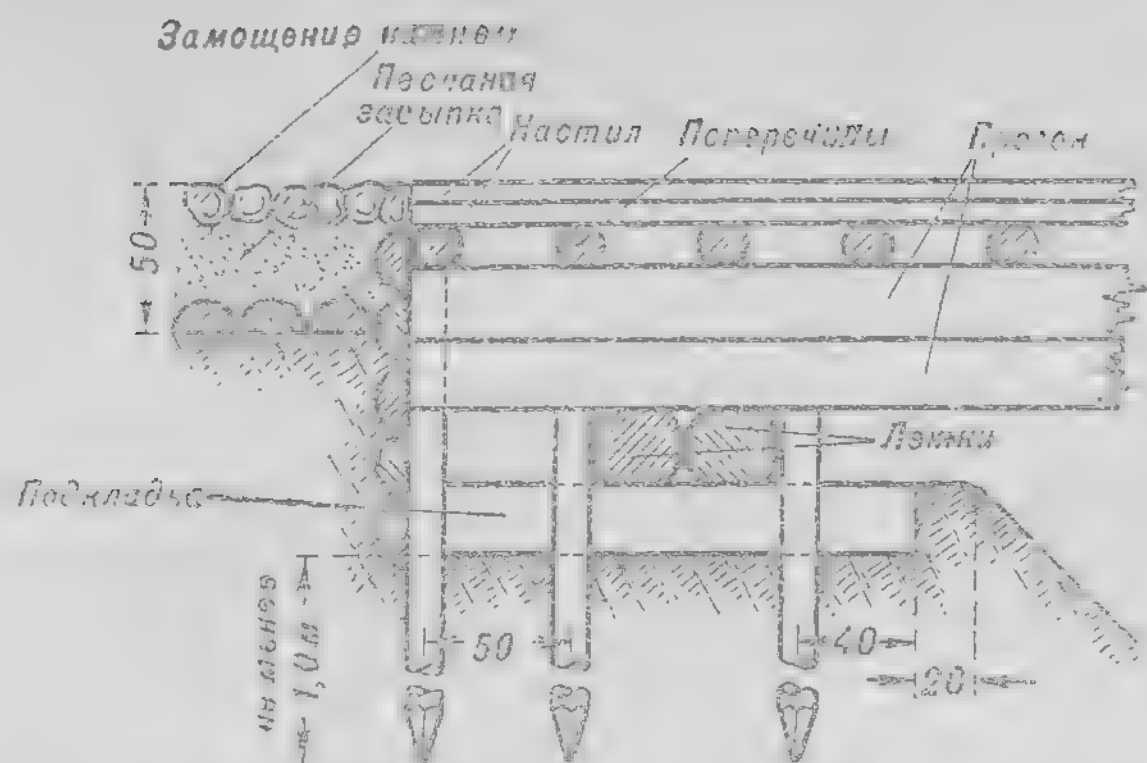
Сопражение моста с берегом. Береговая опора на лежнях (разрез по оси моста).
